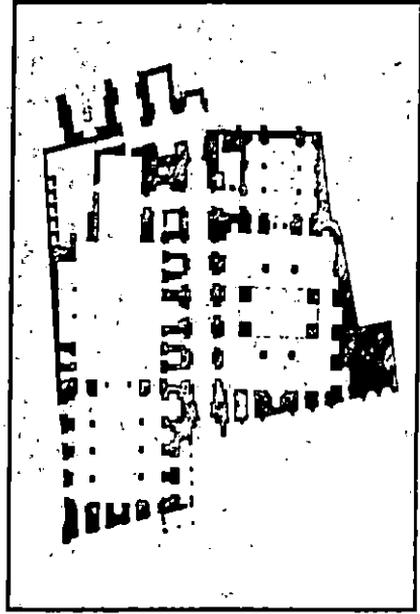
مسقط أفقي خانقاة خوند طغاي عن
